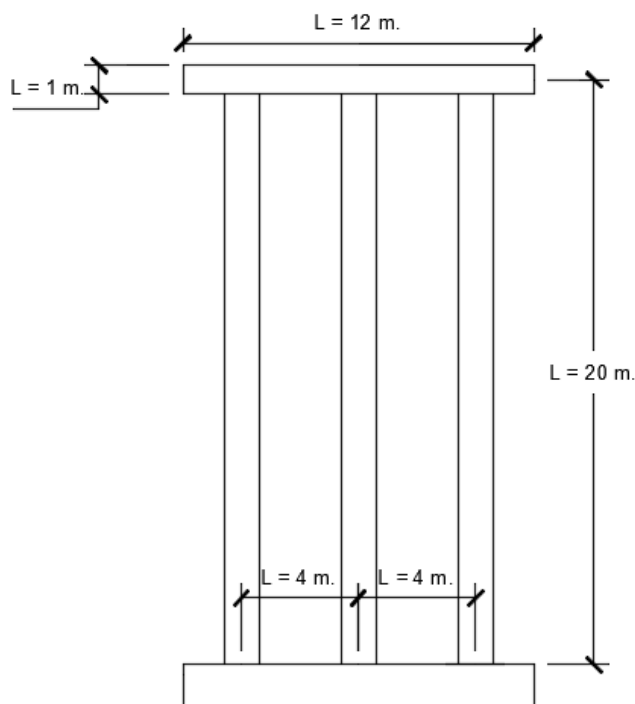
Vista en elevación de la sección de los pilares 1 y 3 con su respectiva viga conectora (Fuente: elaboración propia)
